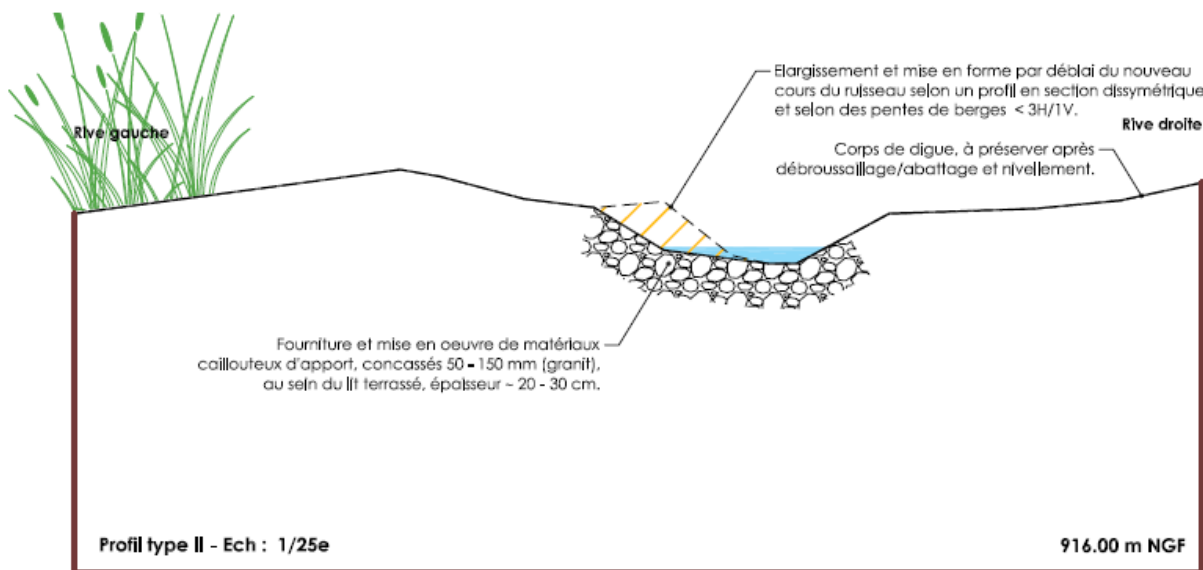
Profil en travers type des travaux de réhabilitation du bras de contournement en bras principal (source : Biotec)
